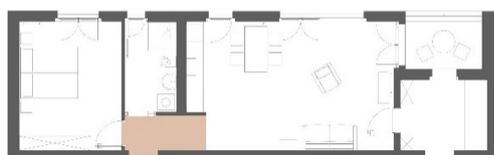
Grundriss Musterwohnung Freilassing
